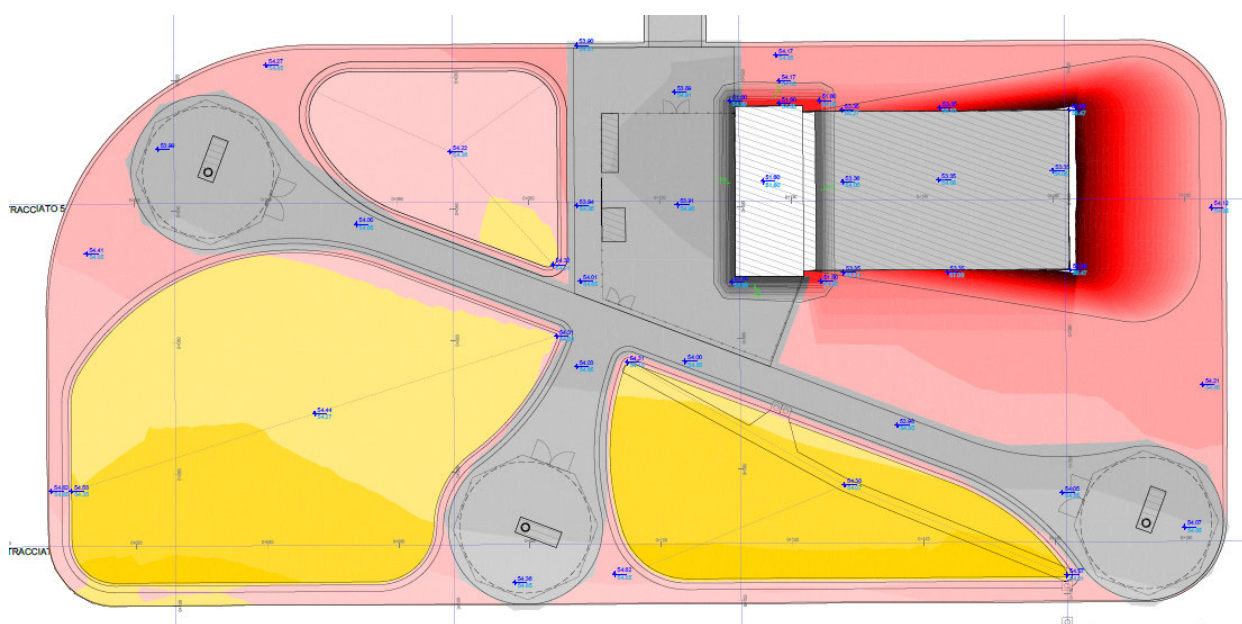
Planimetria fase 2 movimenti terra con indicazione in giallo delle arre soggette a scavo per realizzazione depressioni terreno, e in rosso i rinterri e rilevati.
